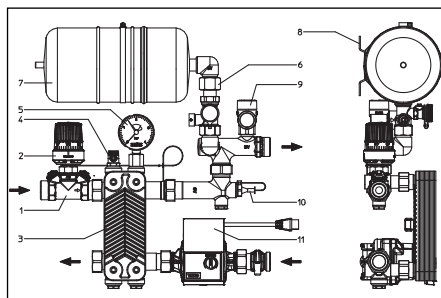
Dettaglio del gruppo „Regufloor HX“
